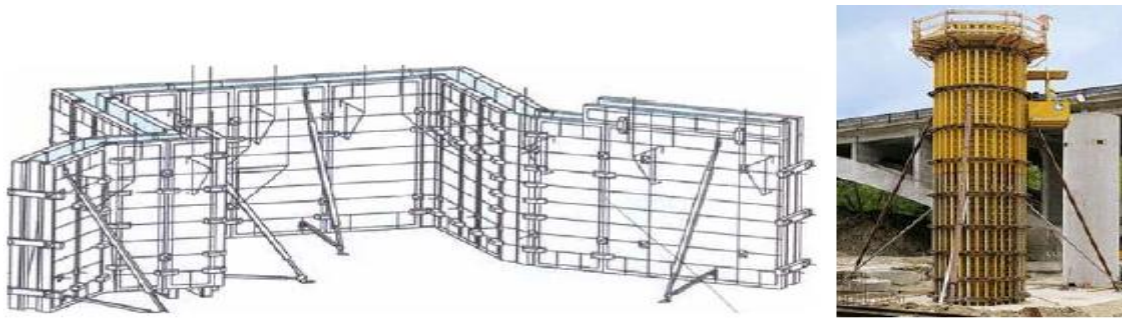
Sistema de painéis para paredes, vigas e pilares [9]
